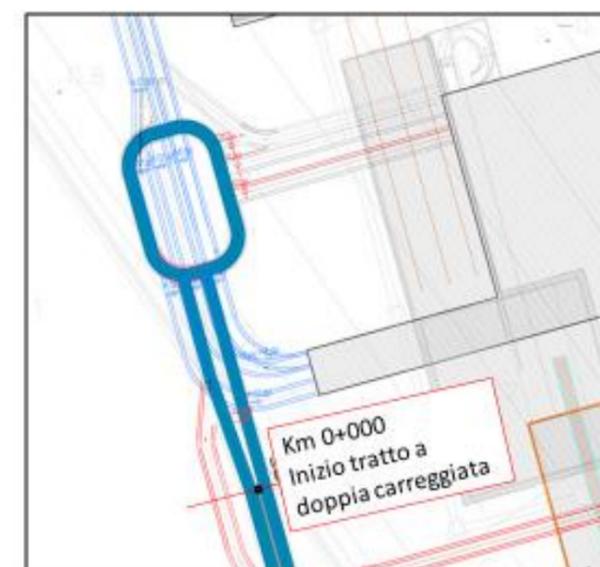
Dettaglio dell'inizio della strada a doppia carreggiata
